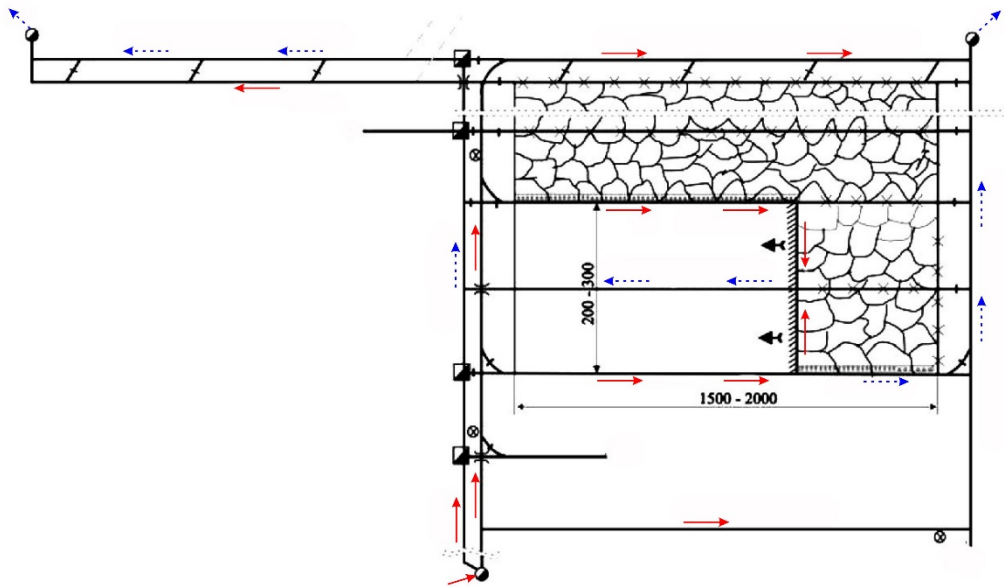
Схема підготовки та відробки виїмкового стовпа [3]
